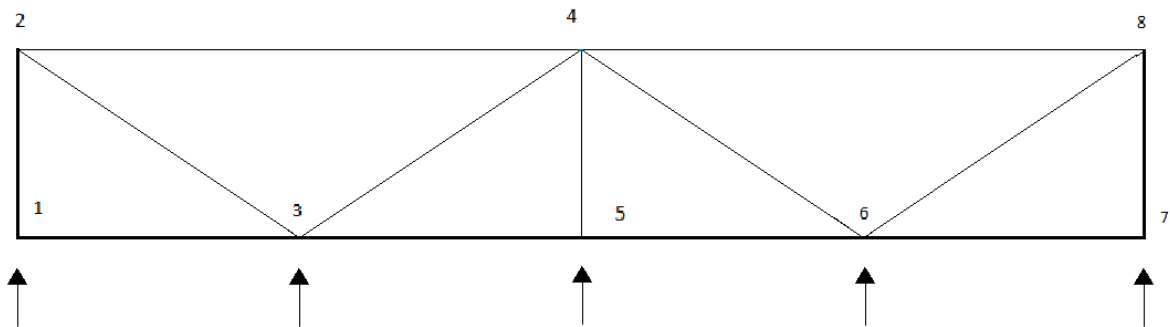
Elementos de la viga contraviento a dimensionar.
